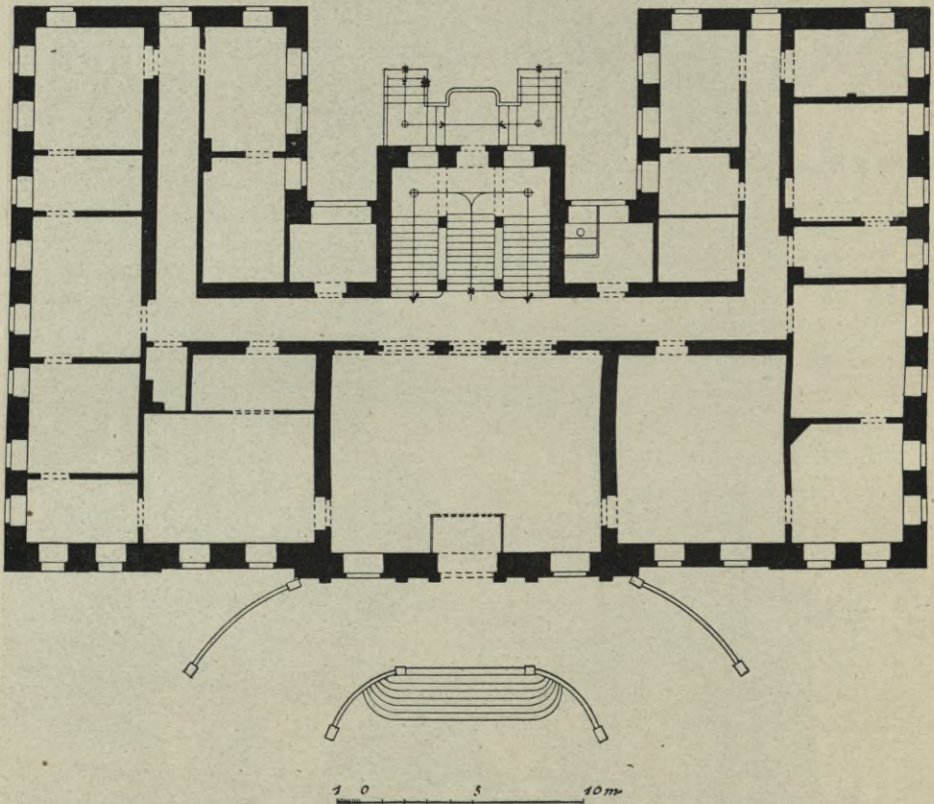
Wachau, Schloss, Grundriss des Erdgeschosses.
